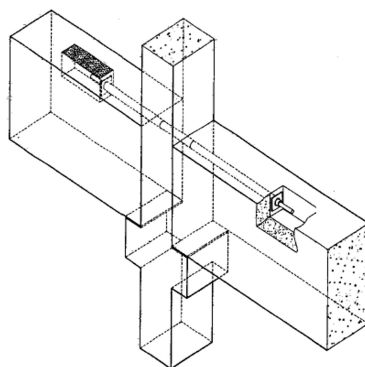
Exemplo de ligação viga-pilar por consola curta de betão e pré-esforço. Adaptado de [6].
